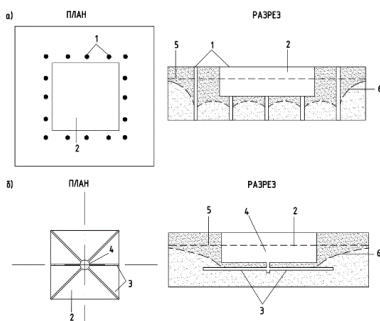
Схема строительного осушения котлована вертикальными (а) и лучевыми (б) дренажными скважинами
